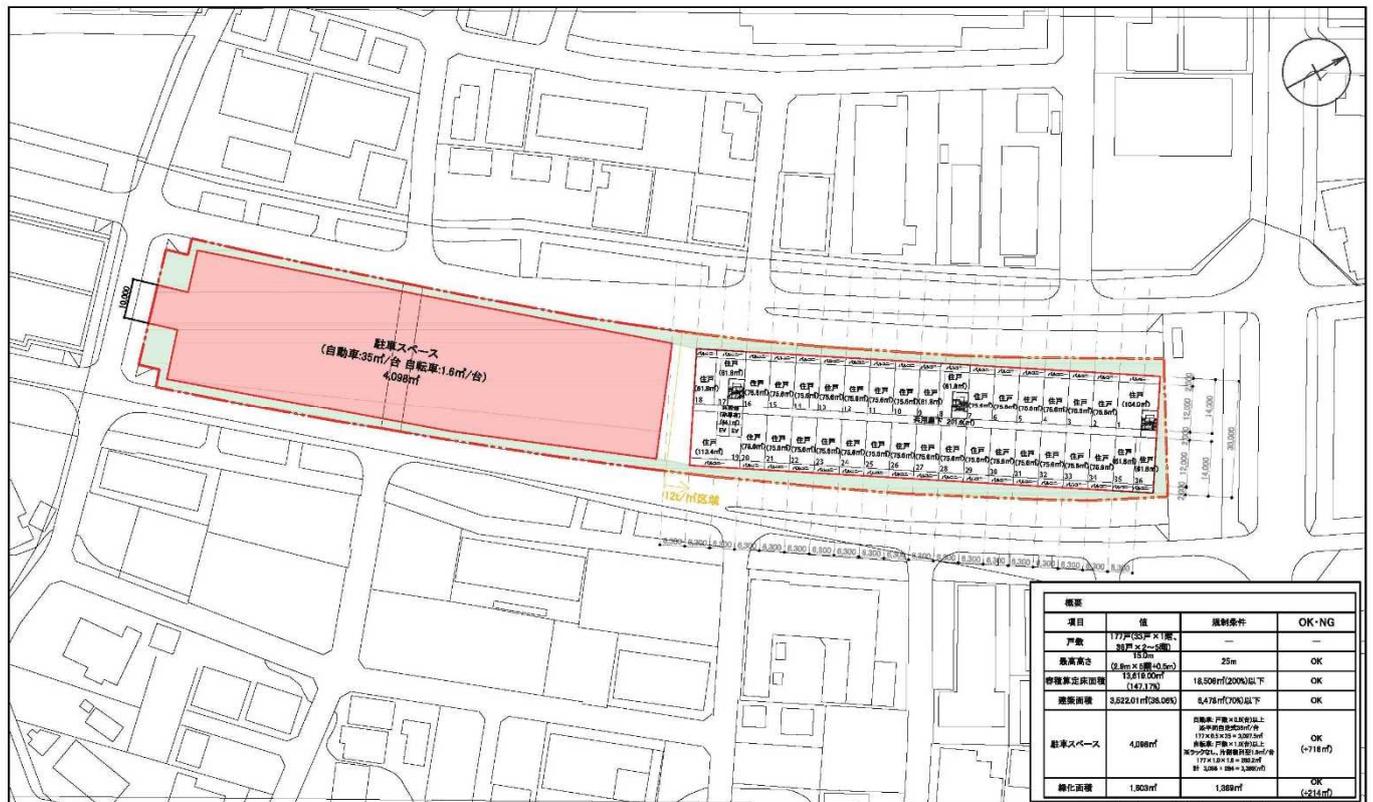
外環による制約がある場合の分譲マンション計画 2〜5階平面図
